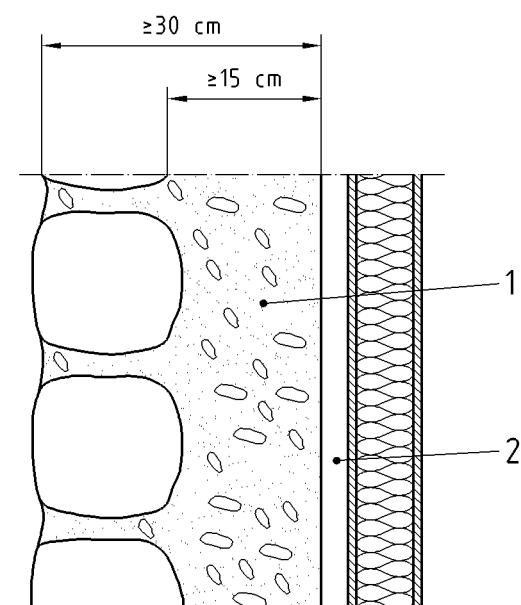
Exemple de mur composite (maçonnerie et béton banché)
